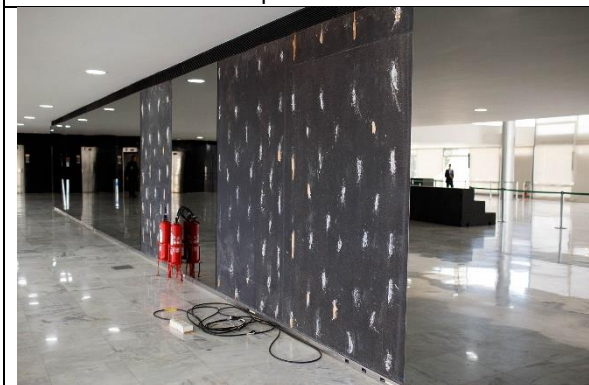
Espelhos quebrados em paredes do 2º e 3º pavimentos. A substituição está sendo feita
